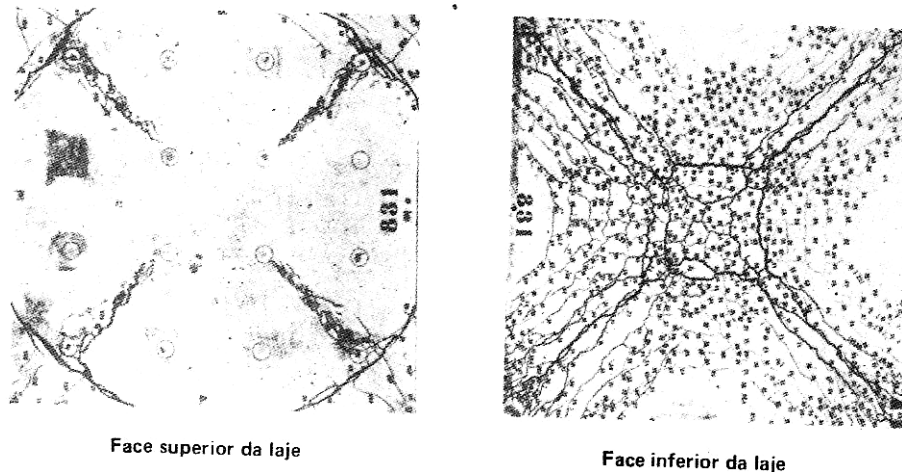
Configuração de fissuras de uma laje de concreto armado retangular sob carga uniforme no estado de ruptura [6]
